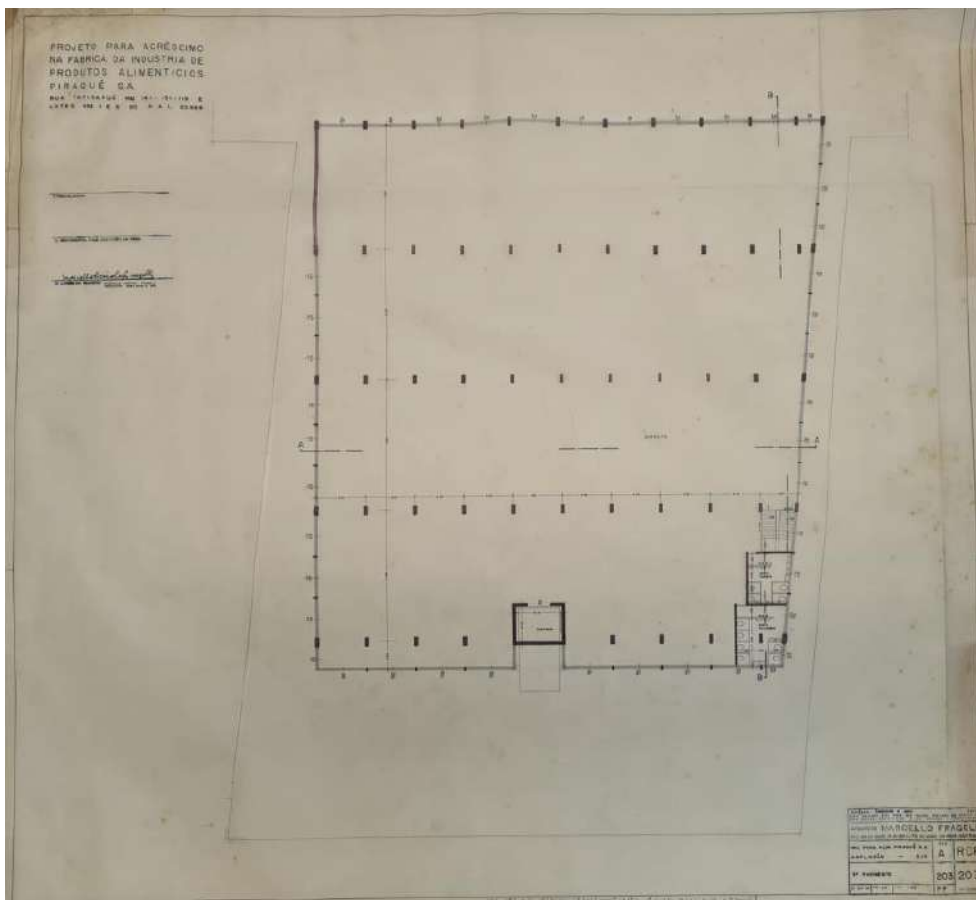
Indústria de Produtos Alimentícios Piraguê. Bloco Tapirapuã. Planta baixa do 3º Pavimento. Data: 21/10/65.
